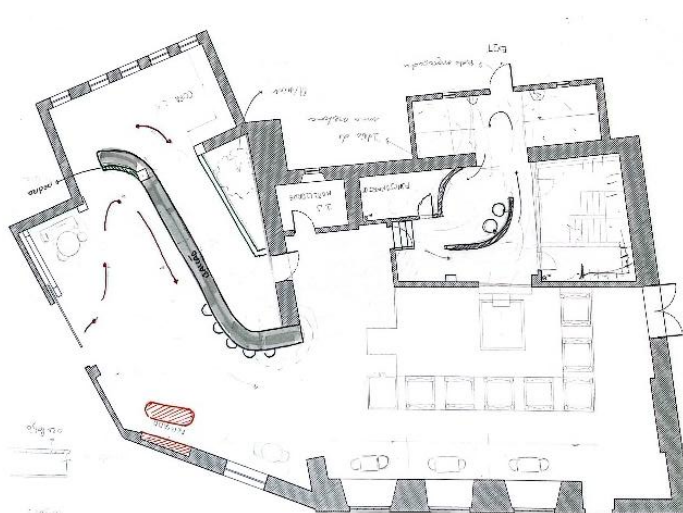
Planta exploratória. (s.d. Fonte: Autora)
